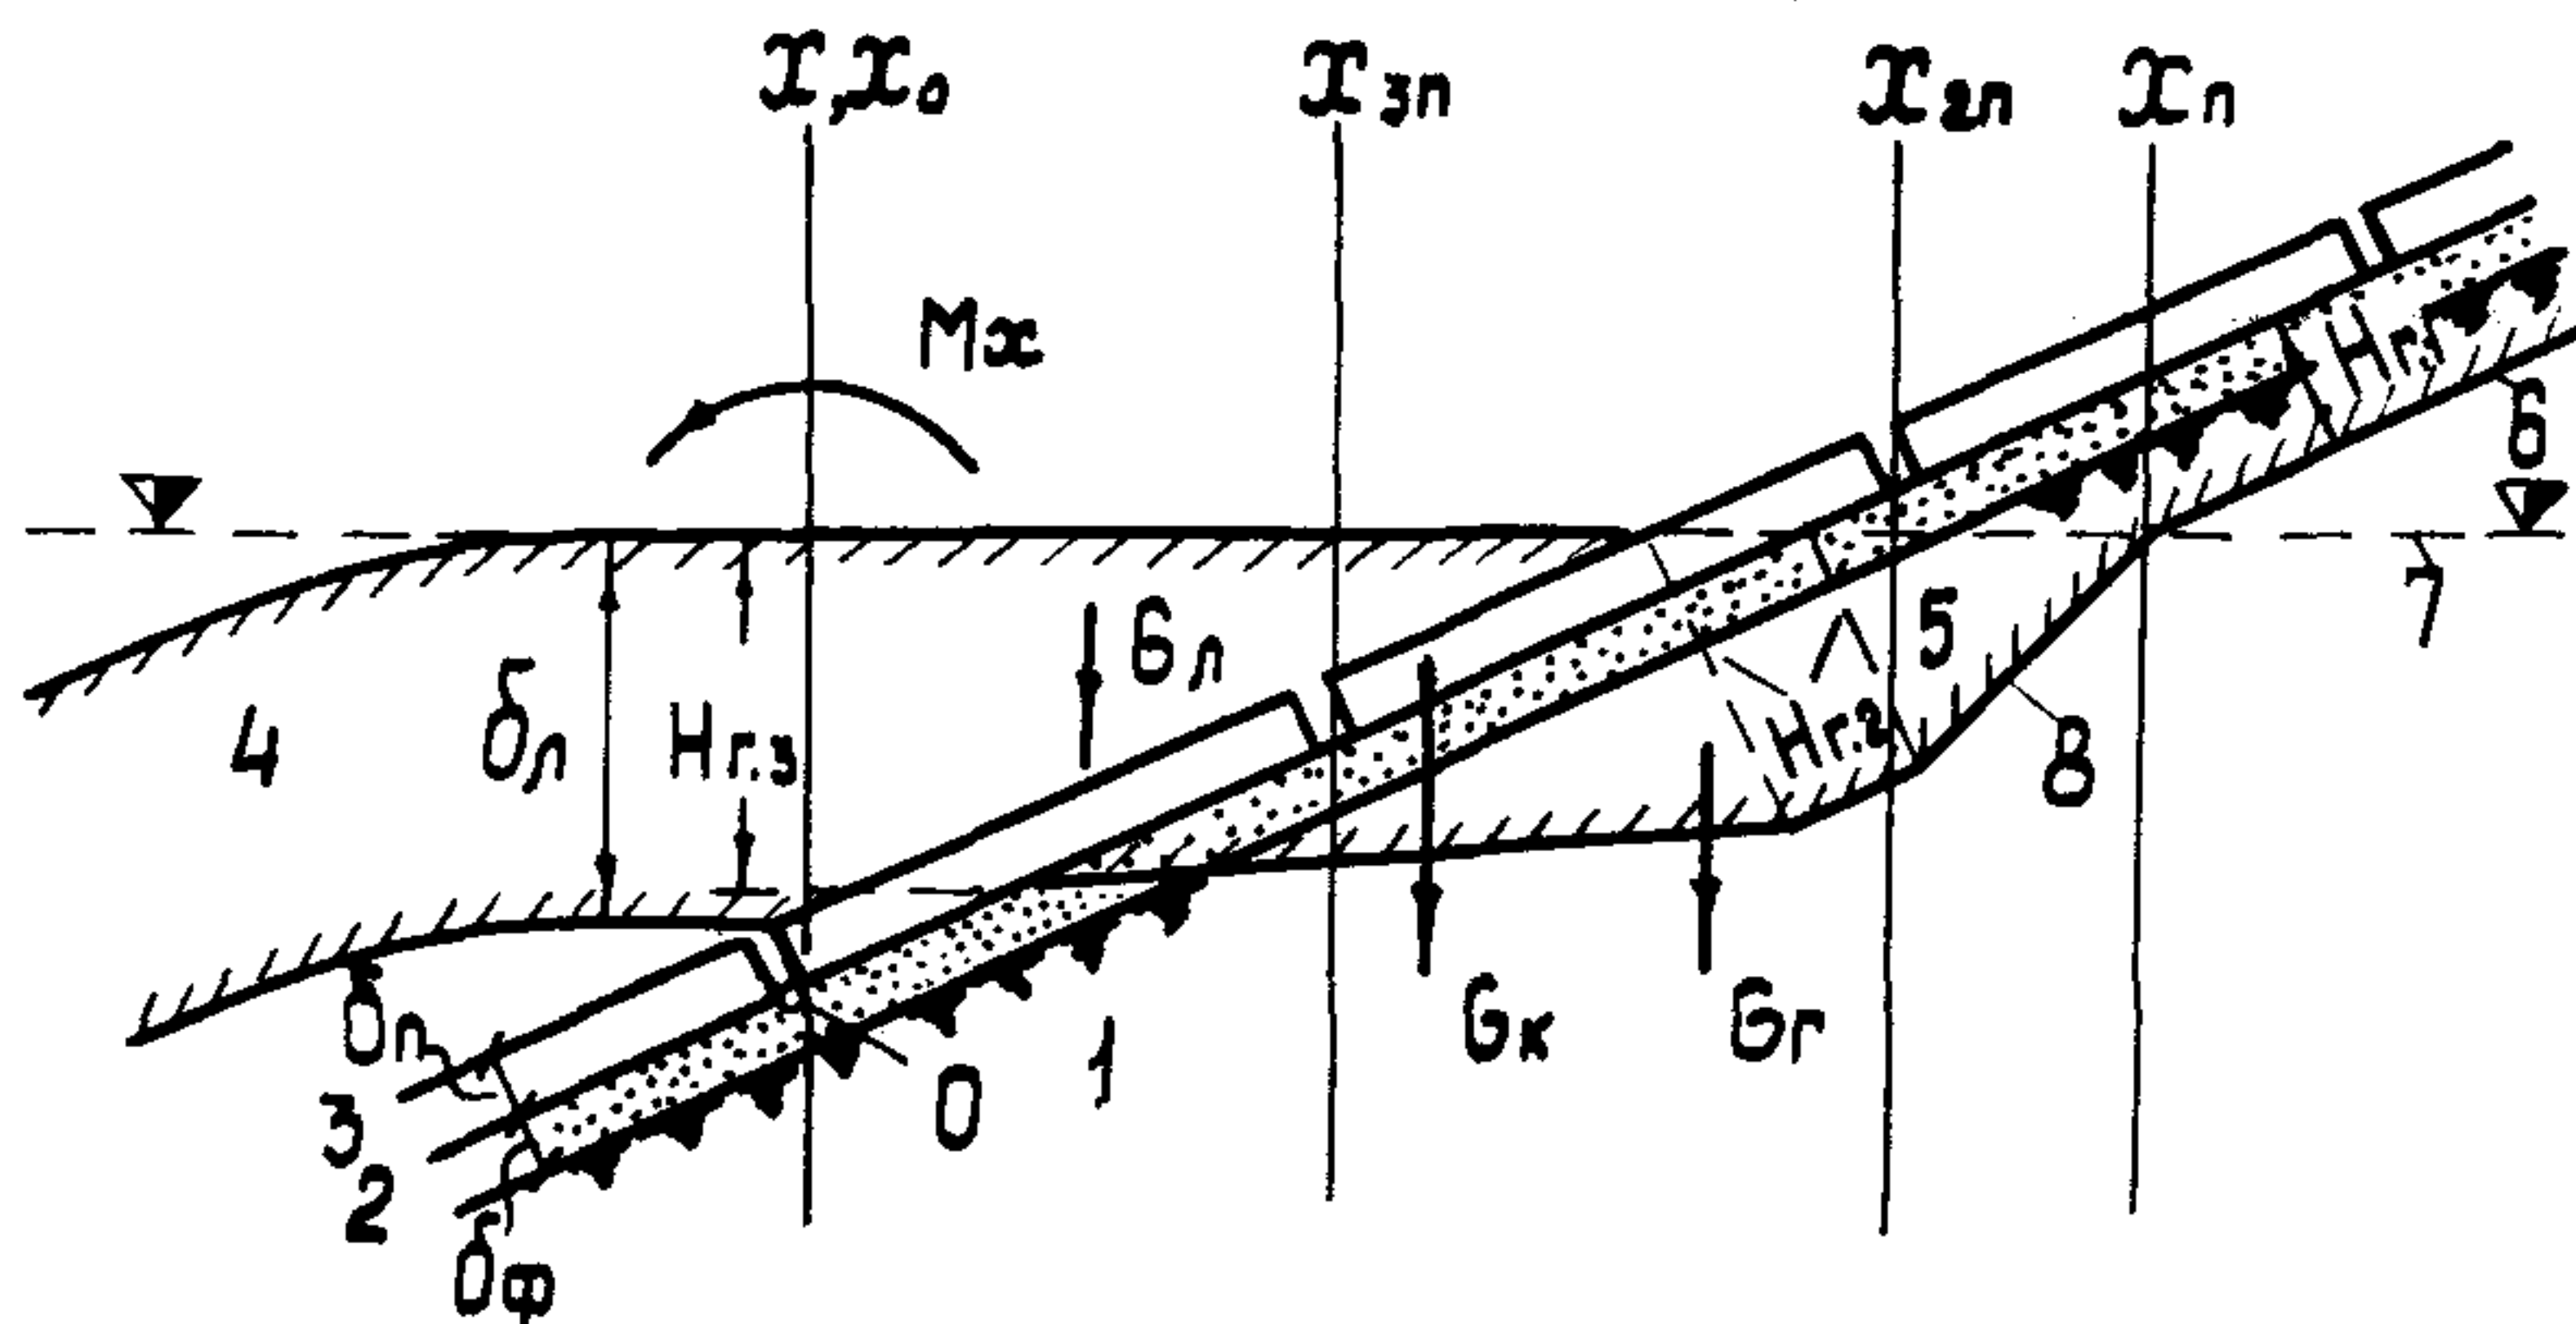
Схема сил к расчету устойчивости крепления при опускании ледяного покрова:
